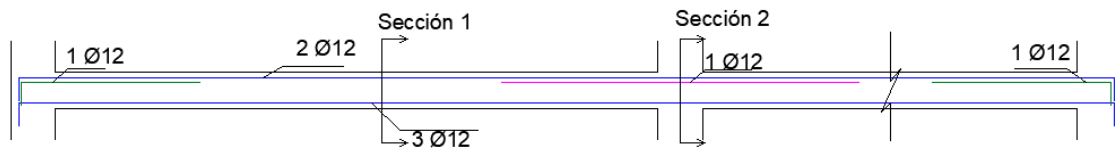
Diseño del acero de refuerzo de viga de entrepiso. Vista lateral [Autores]
